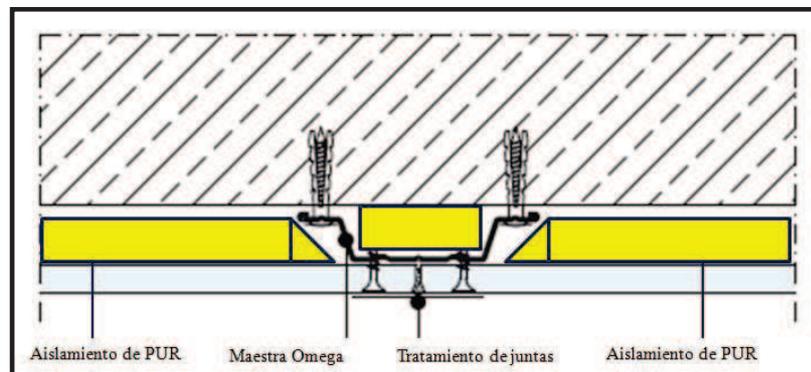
Detalle de aislamiento en junta de placas laminadas de cartón-yeso.
